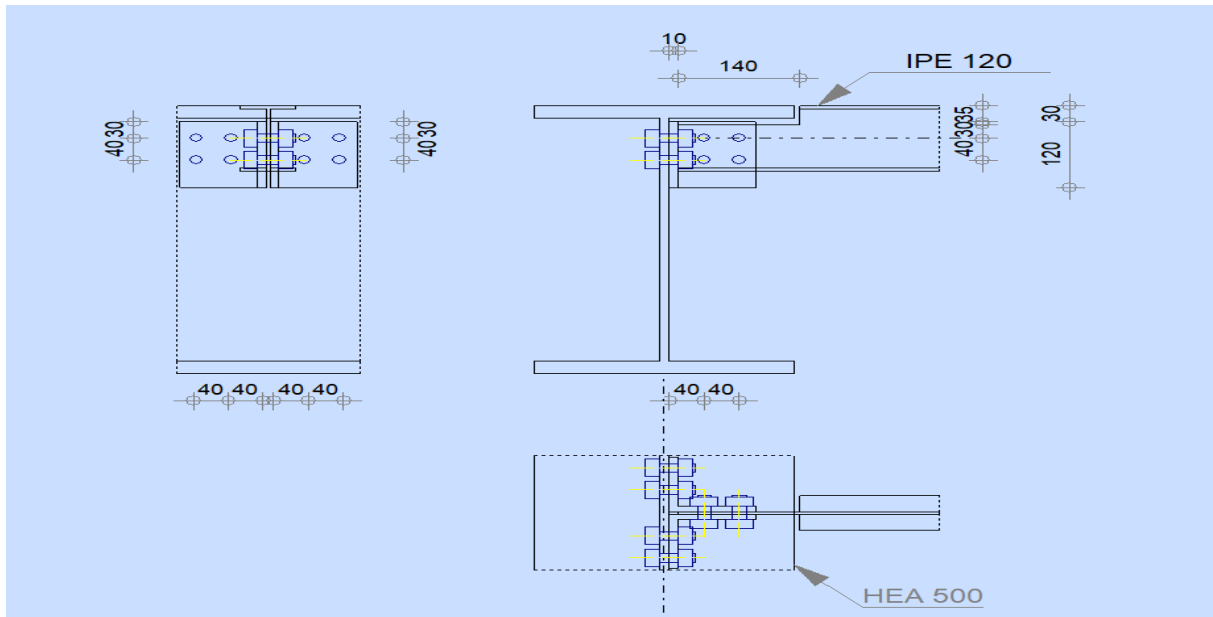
Détail d'assemblage poutre-solive (HEA500-IPE120)
